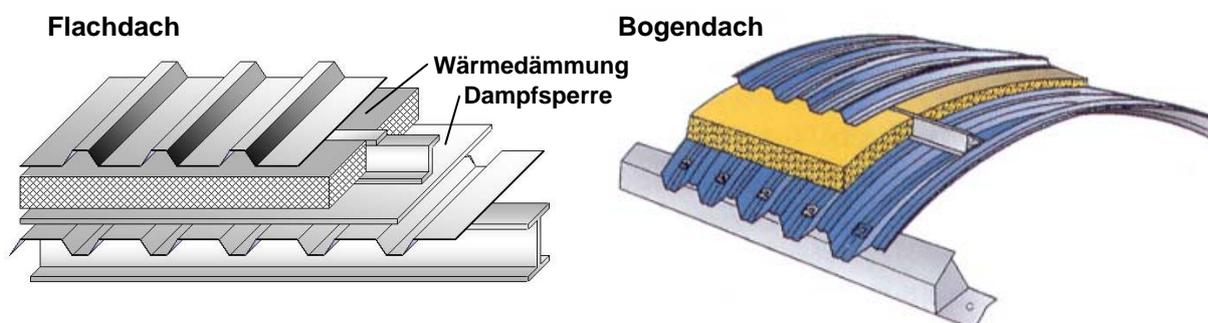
Aufbau zweischaliger, wärmedämmter nicht hinterlüfteter Trapezprofildächer
